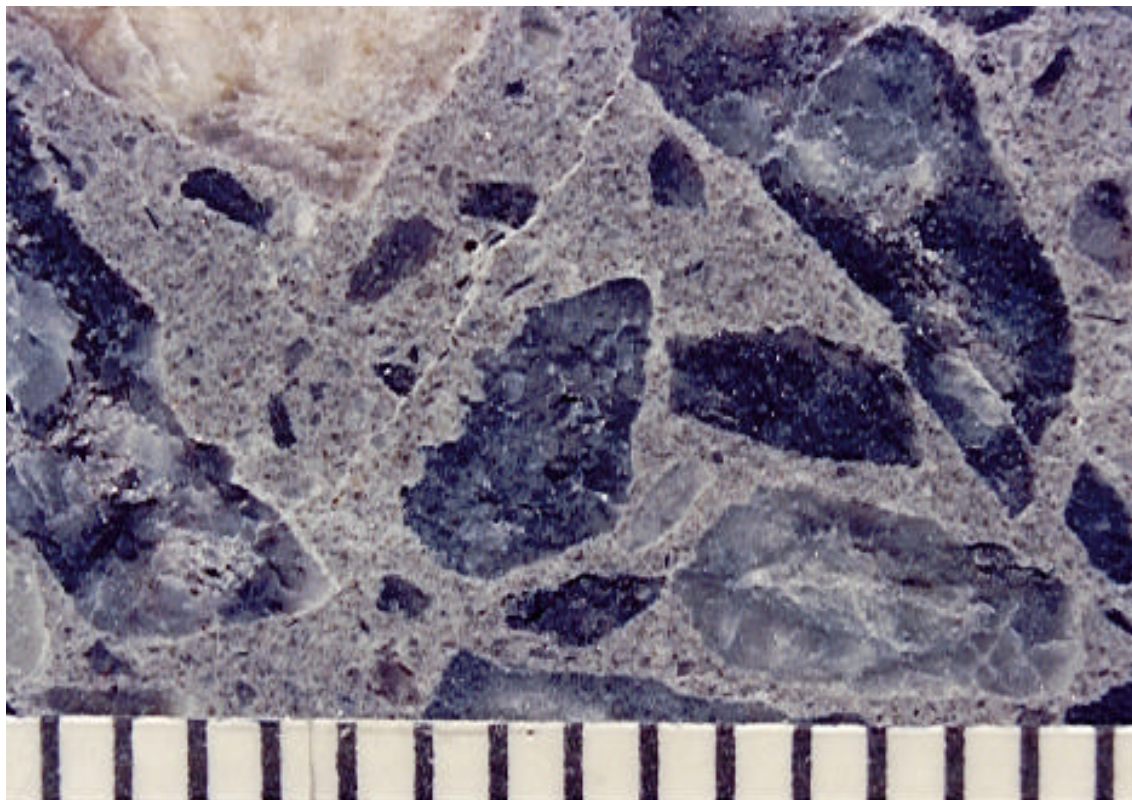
Fissura no Agregado – Obra no Brasil
